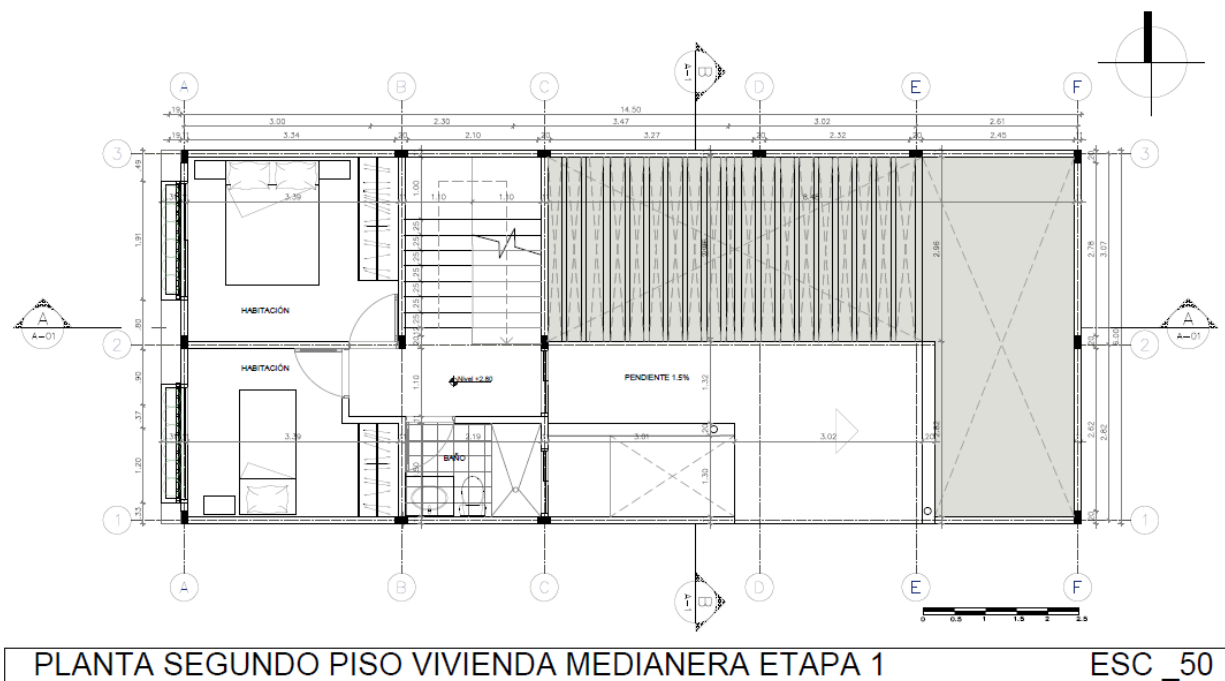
Vivienda en etapa 1 planta primer pisoFigura 57. Vivienda en etapa 1 planta segundo piso
